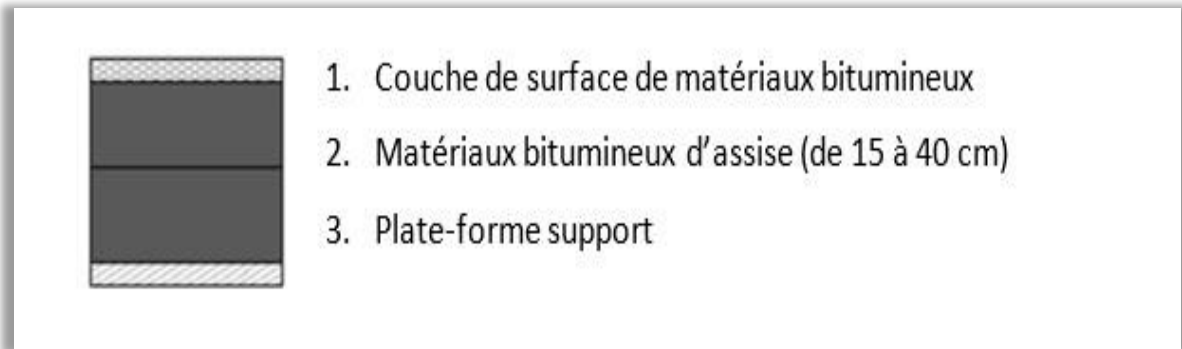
Structure d'une Chaussée bitumineux épaisse
